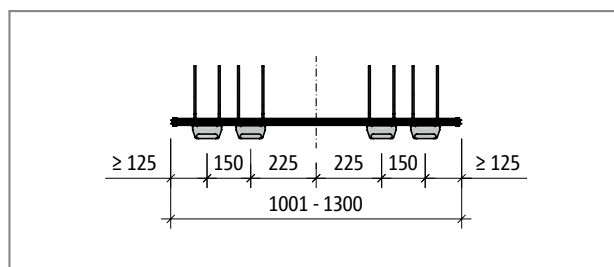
Schöck Tronsole® tipo T-V4-H...-L1001 - L1300, pianta del prodotto
